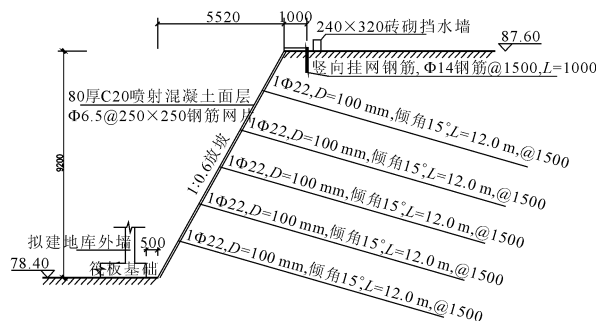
基坑支护结构剖面图(尺寸标注的单位:mm)
